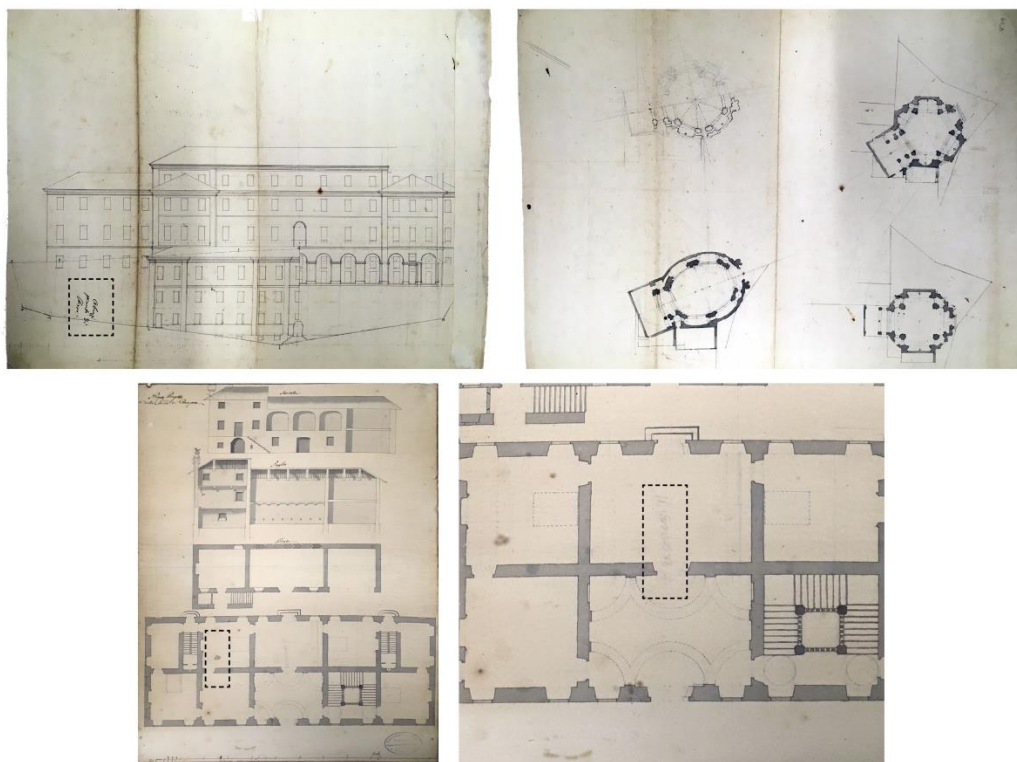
in senso orario: B.A.Vittone, prospetto Monastero di Mondovì e annotazione "Abbozzi piante Chiese" (recto); B. A. Vittone (?), bozze piante di chiese (verso) (Torino, Musei Civici); B. A. Vittone (?), prospetto, sezione e planimetria della "Cascina di Gherpore" e particolare della planimetria con annotazione a matita: "da copiarsi" (Torino, Musei Civici).
